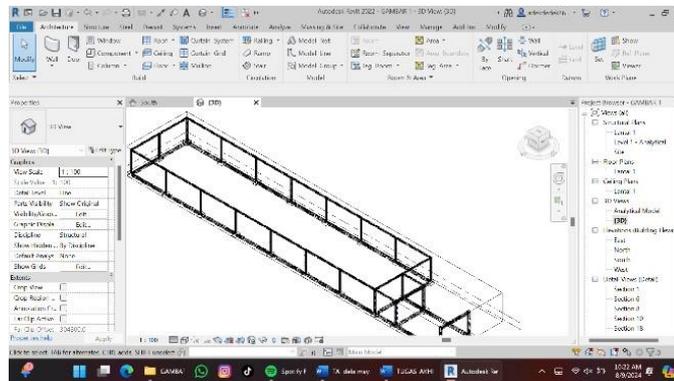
Pemodelan 3D Struktur Plat Lantai
